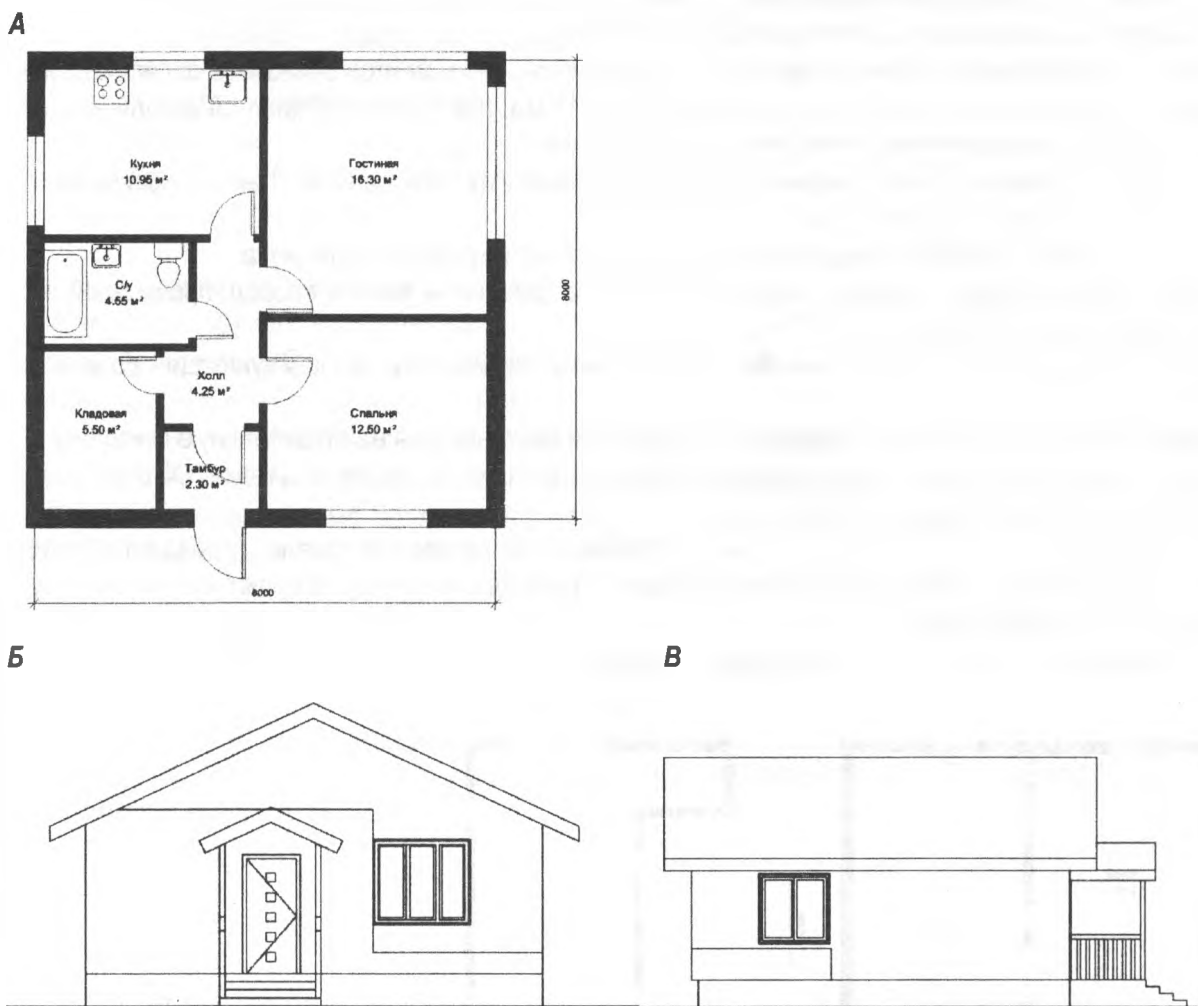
А-план 1-го этажа; Б-фасад фронтальный; В-фасад боковой
